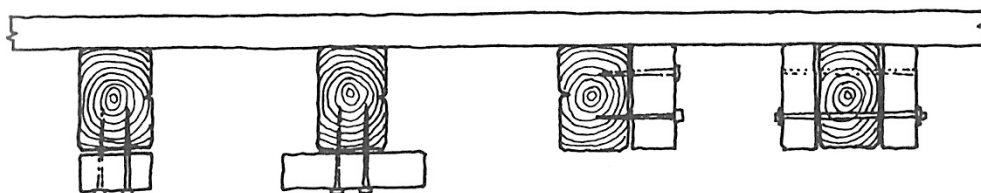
Tipos de reforços das vigas constituintes dum pavimento de madeira. Arriaga [1]
